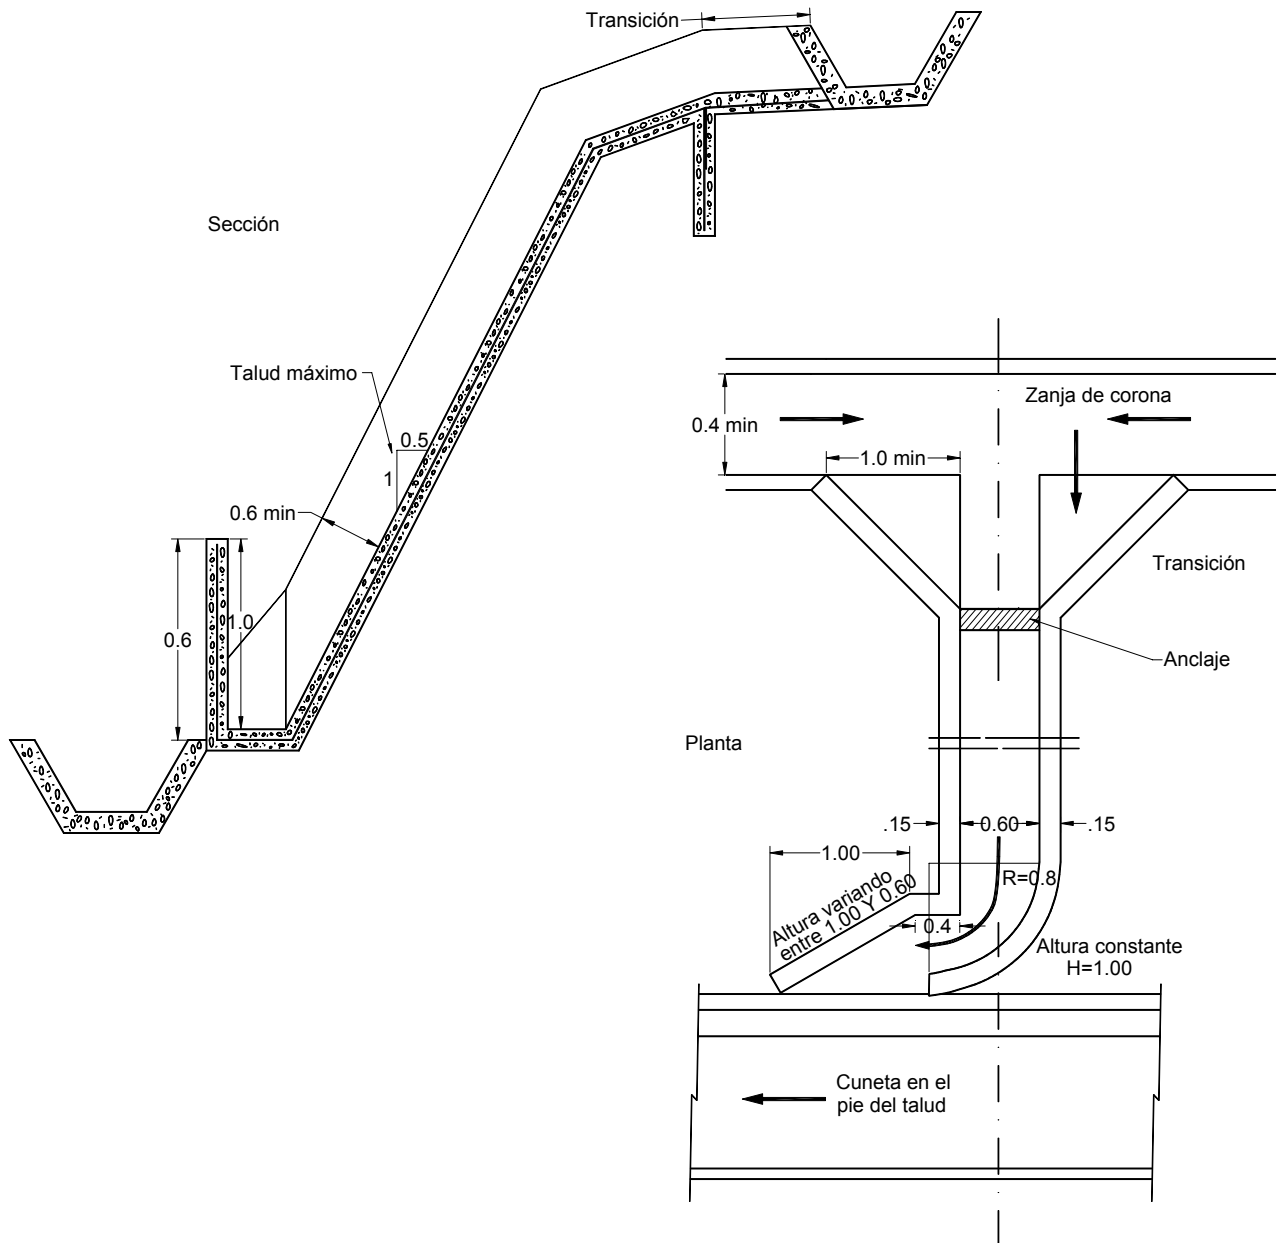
Detalle de una torrentera de canal liso y contravertedero en el pie.
